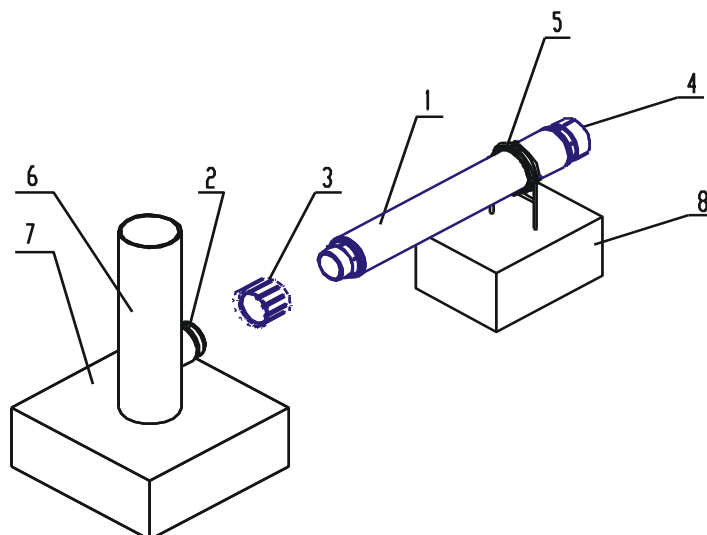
Вариант крепления аэратора с использованием бетонного пригруза
